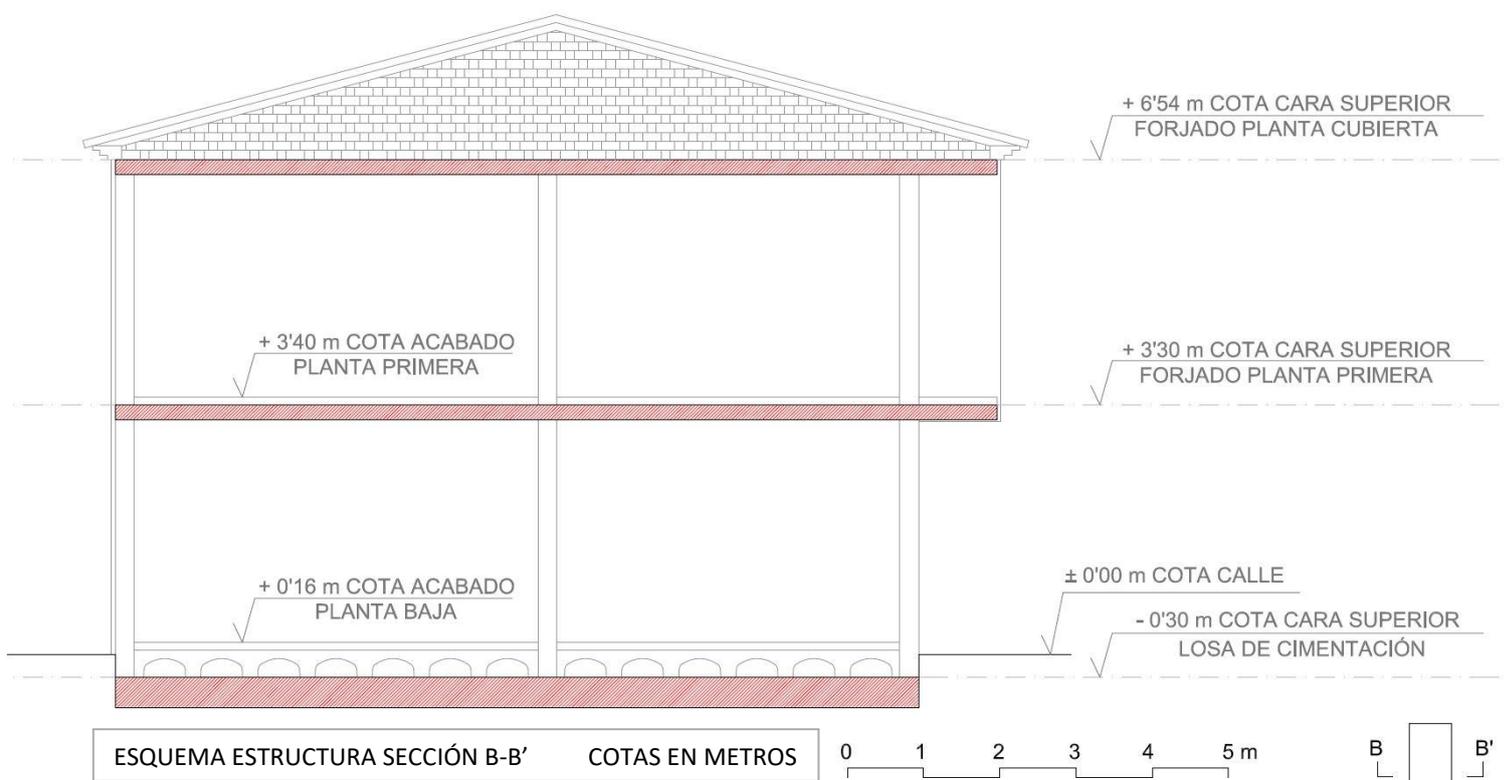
Plano esquema estructura sección transversal B - B', elaboración propia
